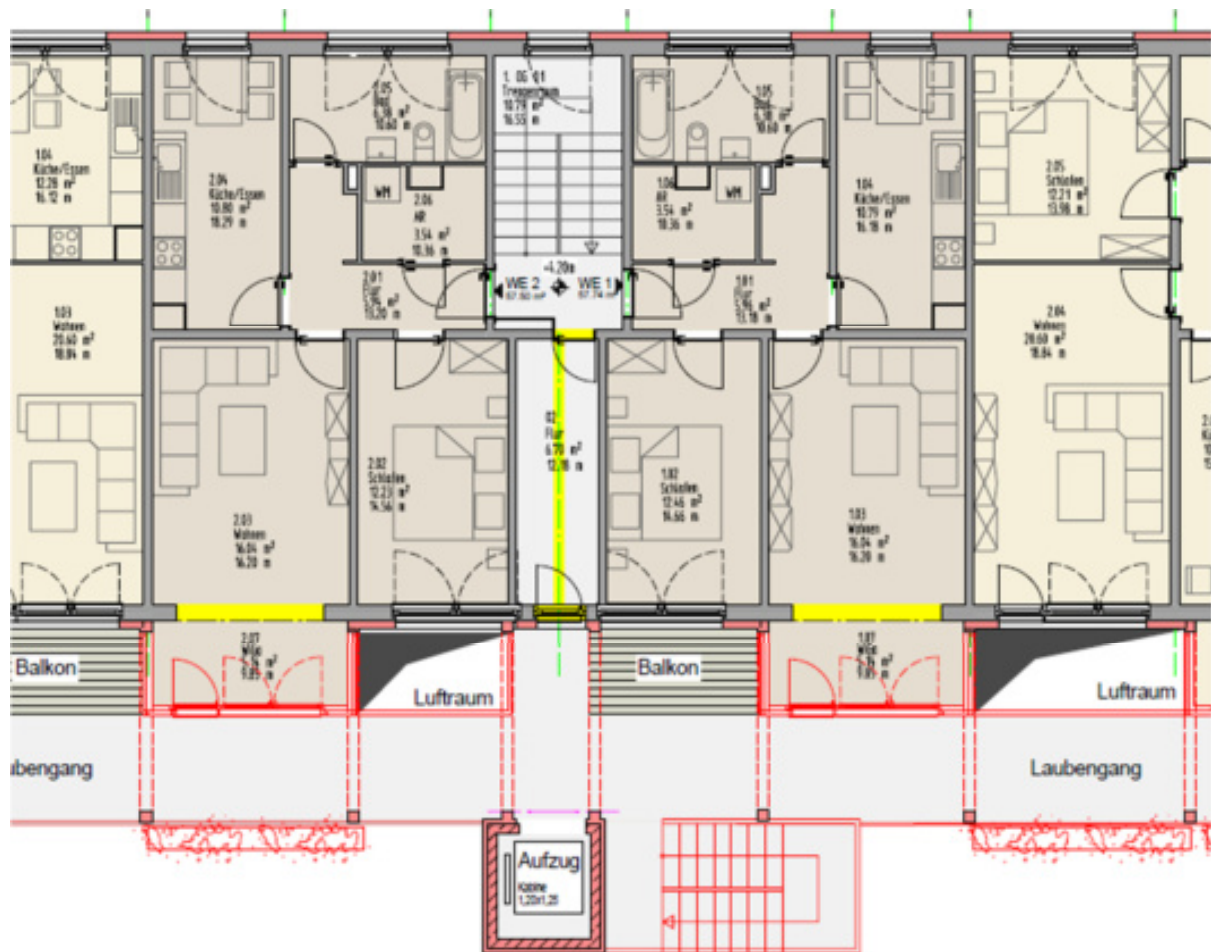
Ausschnitt aus Grundriss zu Var1 mit barrierefreier Laubengängerschließung (Quelle: IBNuP)
